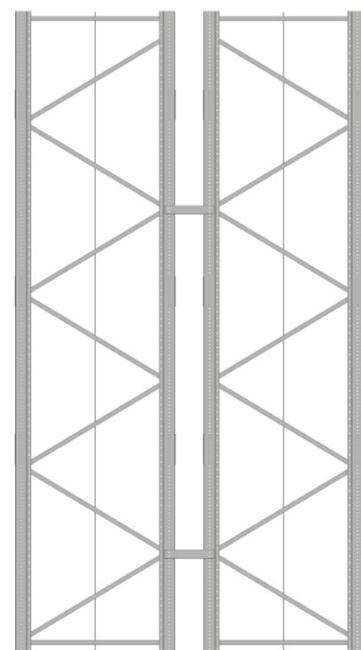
Abstandshalter mit Füllstabausfachung im V-Muster
